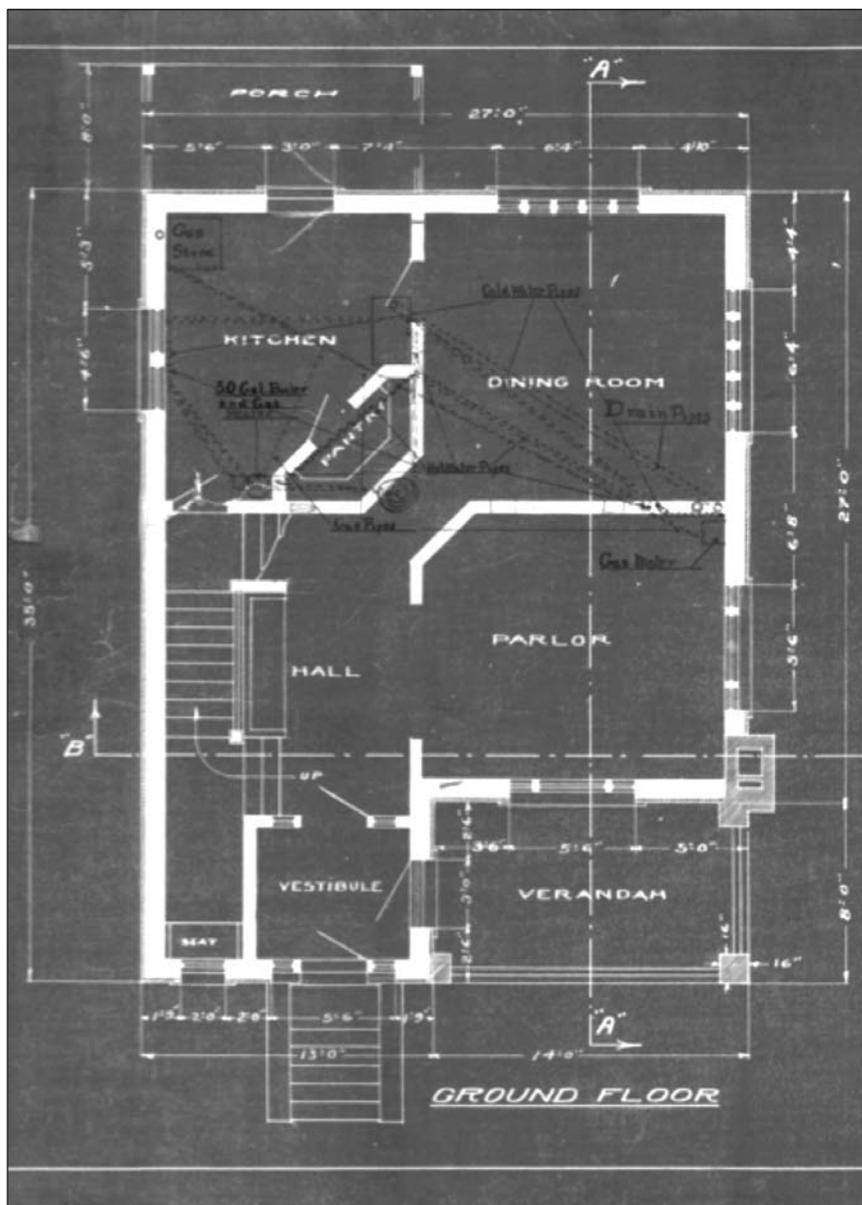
Maison Johnston, plan du rez-de-chaussée, archives privées.
